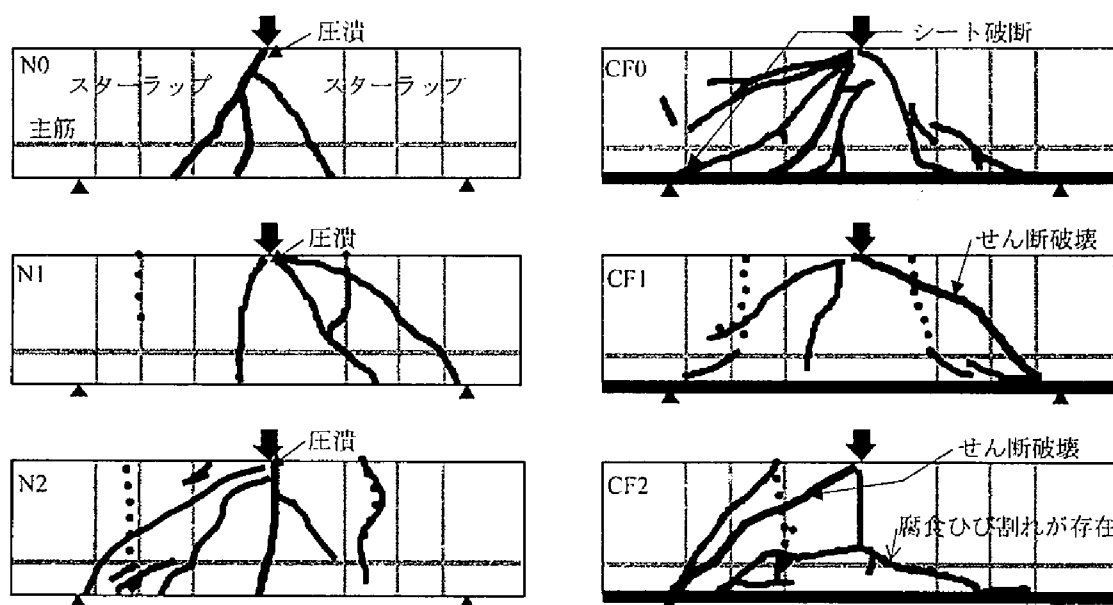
載荷終了後のひび割れ状況 (点線は腐食ひび割れ)
